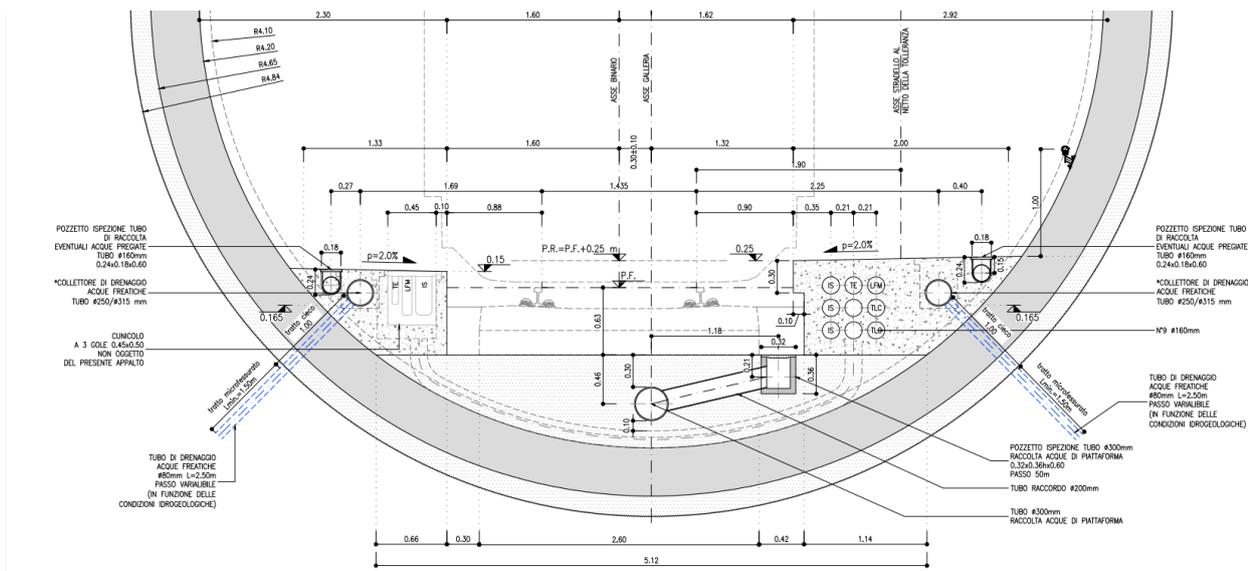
sezione tipologica prevista per il drenaggio definitivo
